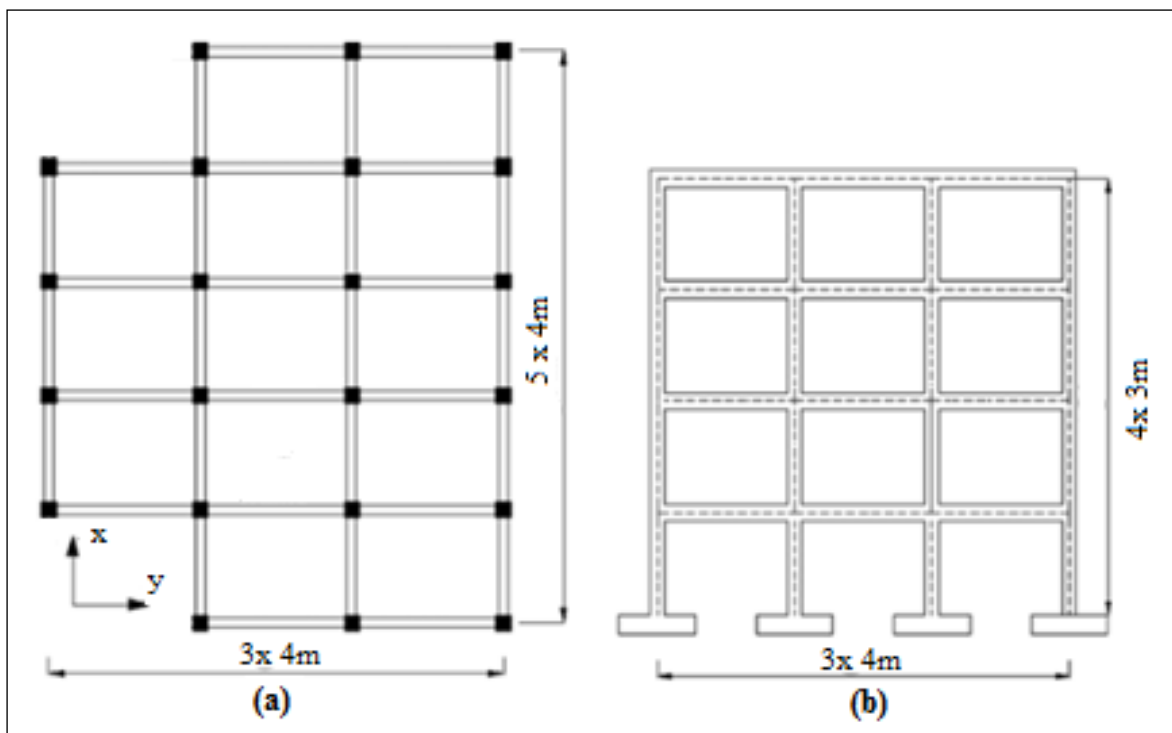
Détails de la structure sélectionnée en plan et en élévation.
